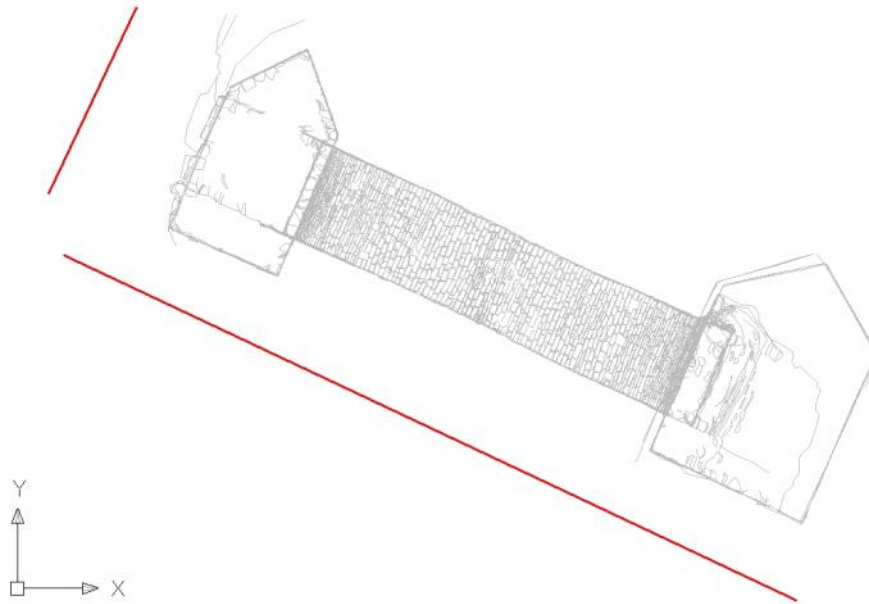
Vista en planta del despiece del arco de la margen izquierda sobre la que se marcan los planos de proyección más adecuados para los alzados.
